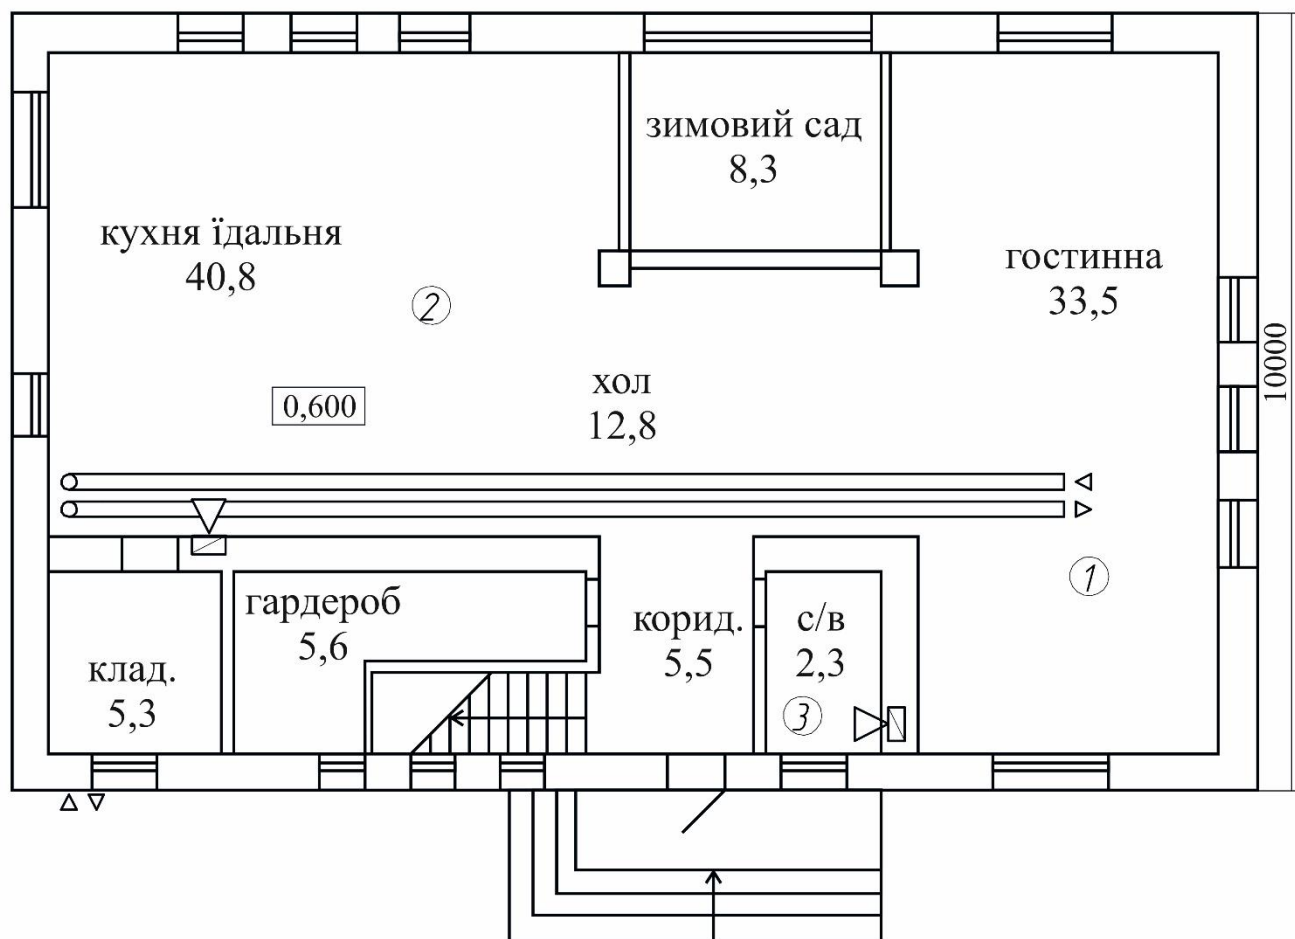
Креслення першого поверху будинку з повітропроводами.
